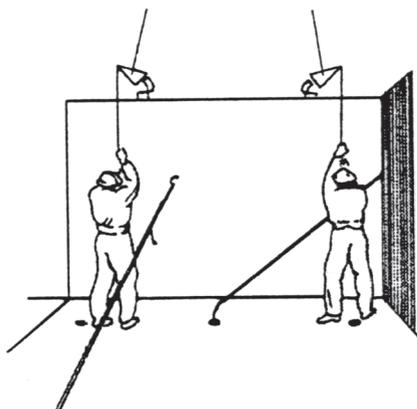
Рабочие операции по расстроповке стеновой панели на монтаже жилого дома
